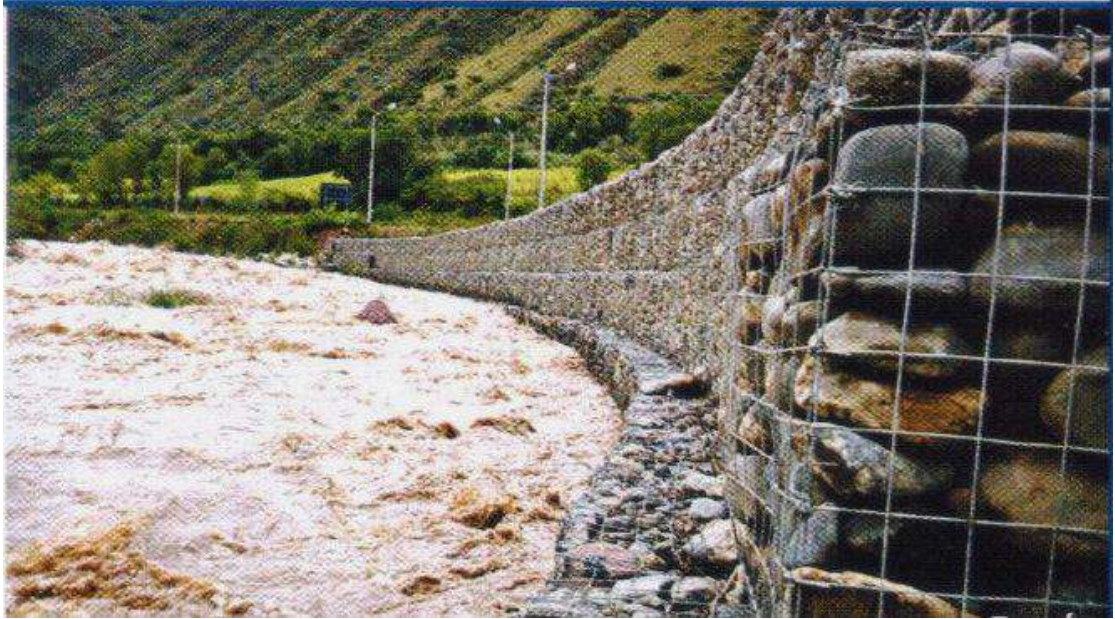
la protección de las riberas rectas de las terrazas bajas erosionadas, se recomienda gaviones en caja con colchones reno para impedir la socavación. Utilizar las gravas que se encuentra en el lecho del lugar.
